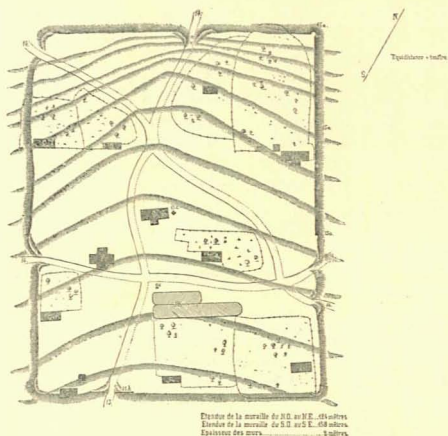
Plan des Fondations d'un Castellum antique retrouvé dans le village de Pétroussa.
